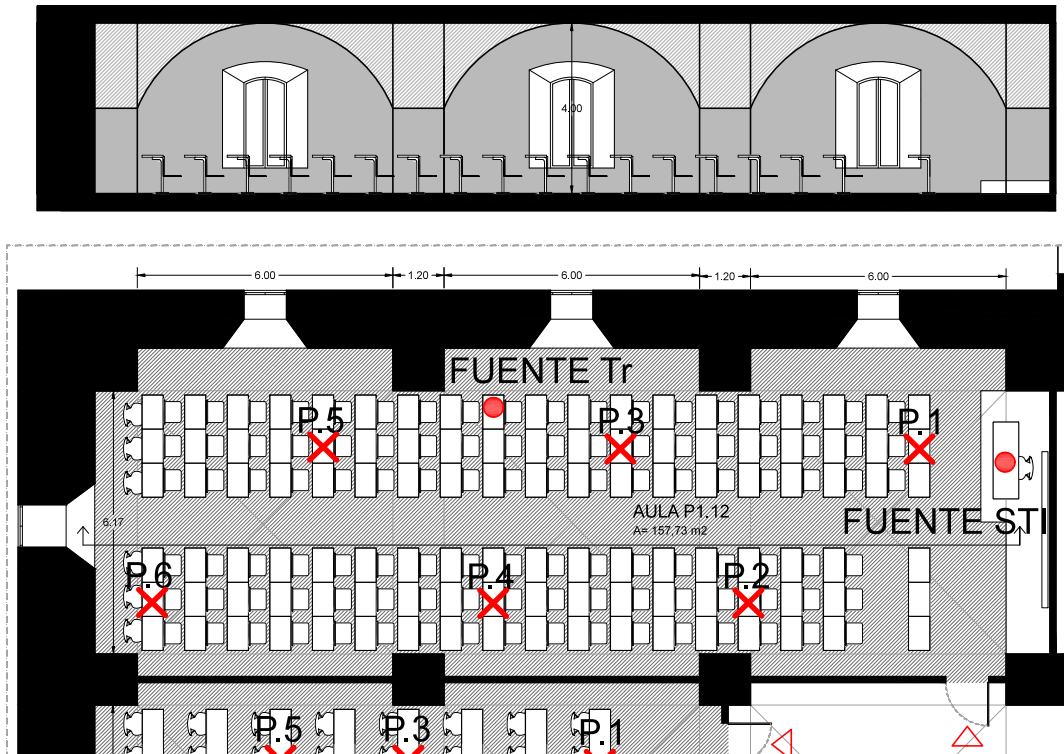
Planta y alzado del aula P1.12 de la ETSIT.
